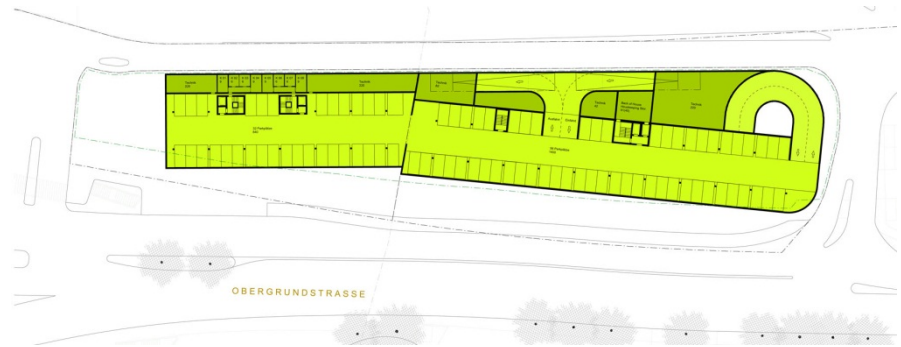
Eine mögliche Erschliessung/Einstellhalle (Plausibilitätsstudie 2011)
